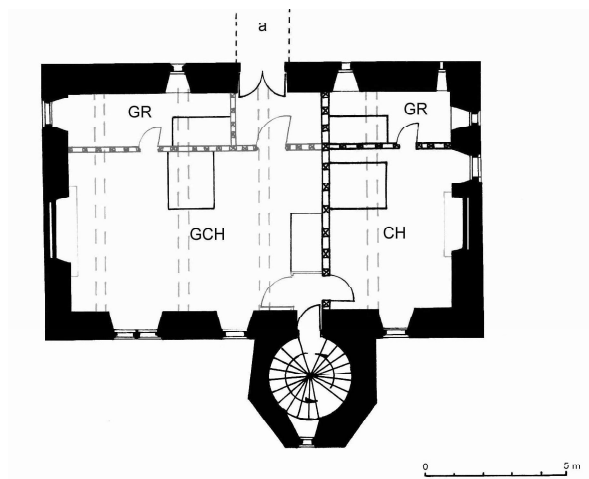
Héronnelles. Plan restitué du premier étage vers 1490-1495.
